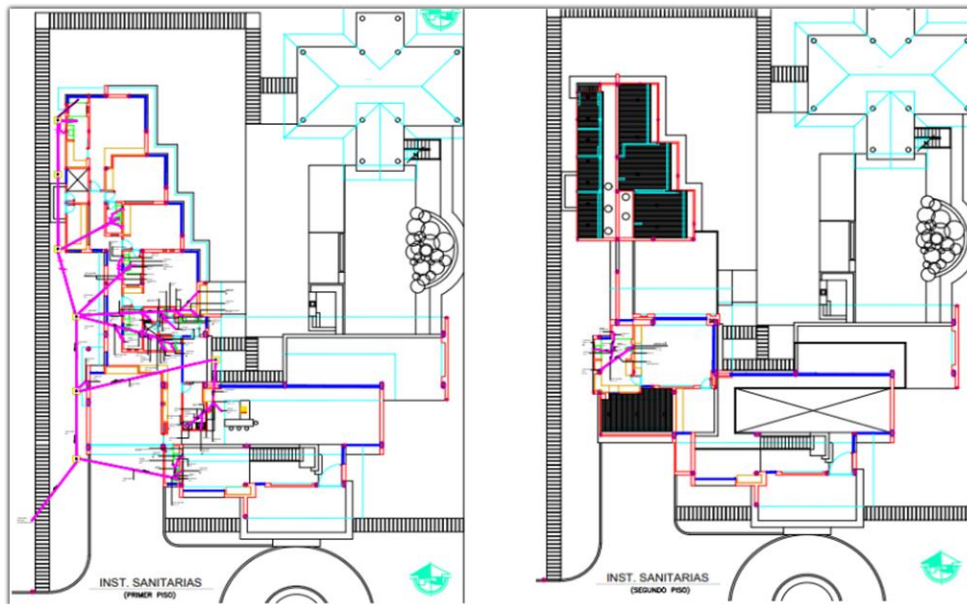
Planta de instalación sanitaria de primer y segundo piso. Fuente: Planos AutoCAD.
